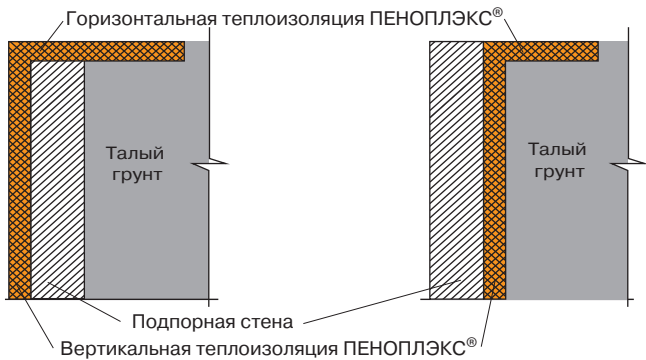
Варианты устройства теплоизоляции подпорной стены
